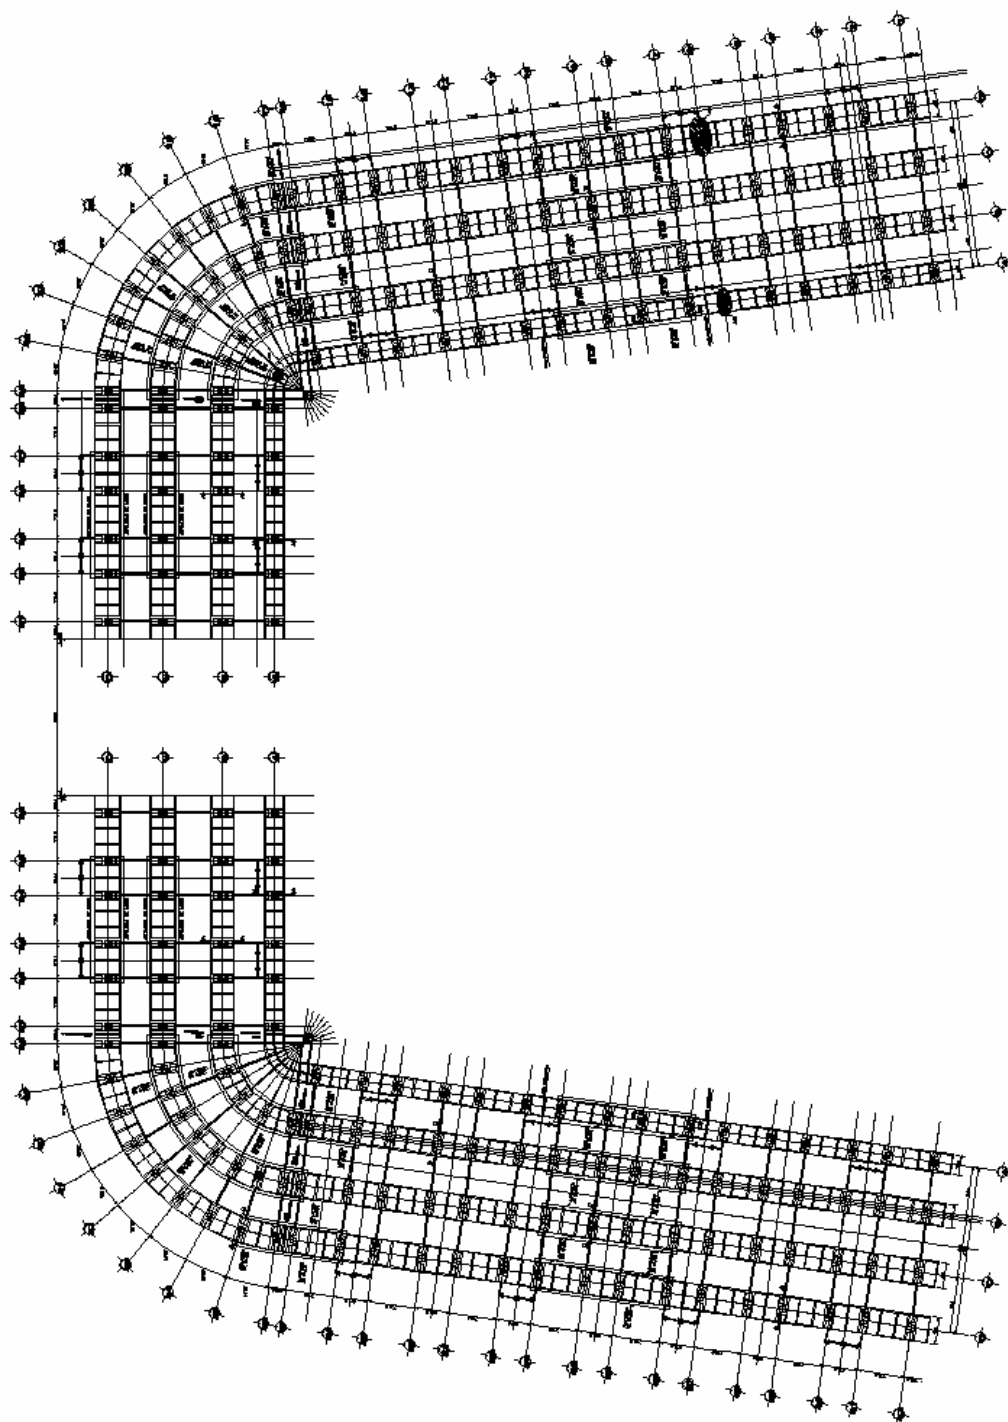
Planta de cimentación general, las dimensiones de los cajones fueron de acuerdo a las
